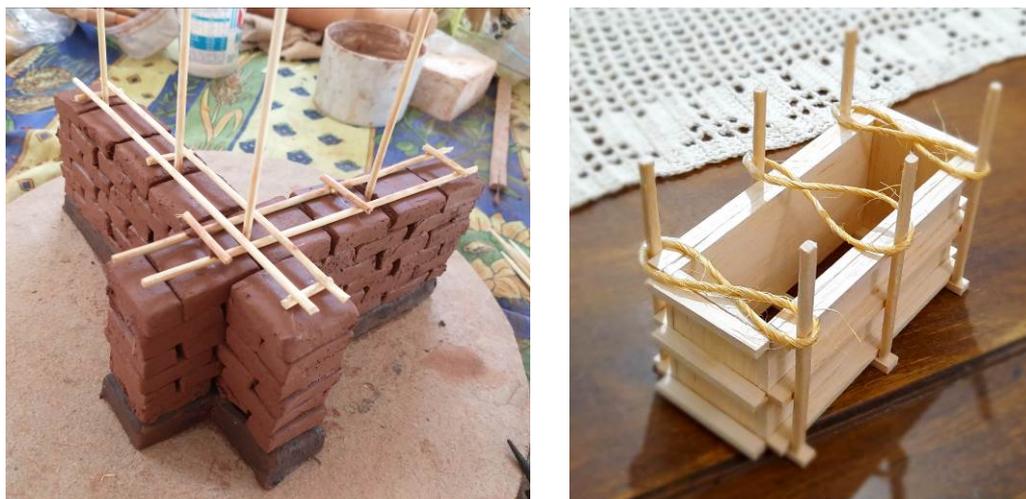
Maqueta a escala de una sección de muro de adobe reforzado y molde para tapial (Crédito D. Ferreira)
